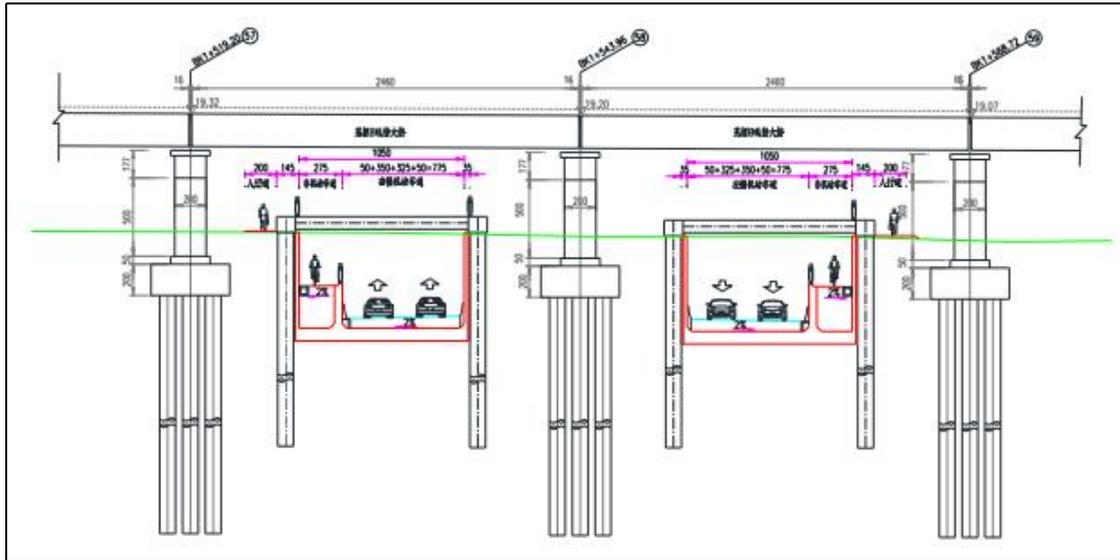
下穿芜湖东联络 B 线横断面图
